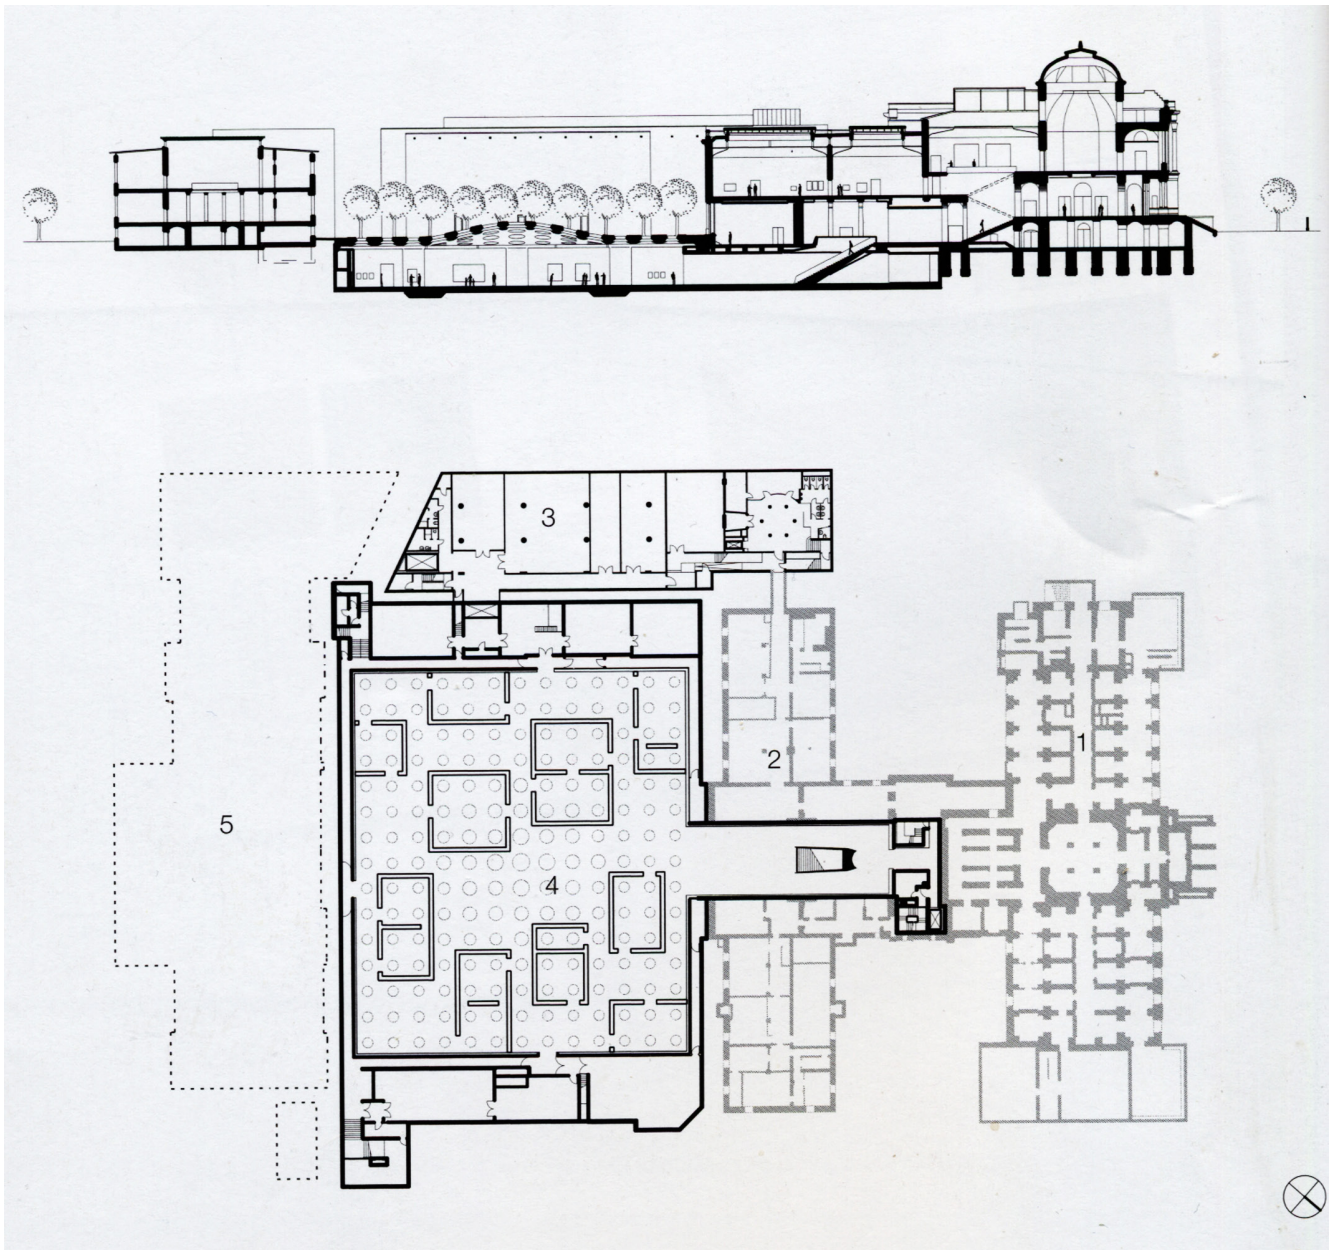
Schnitt und Grundriss des Zubaus
